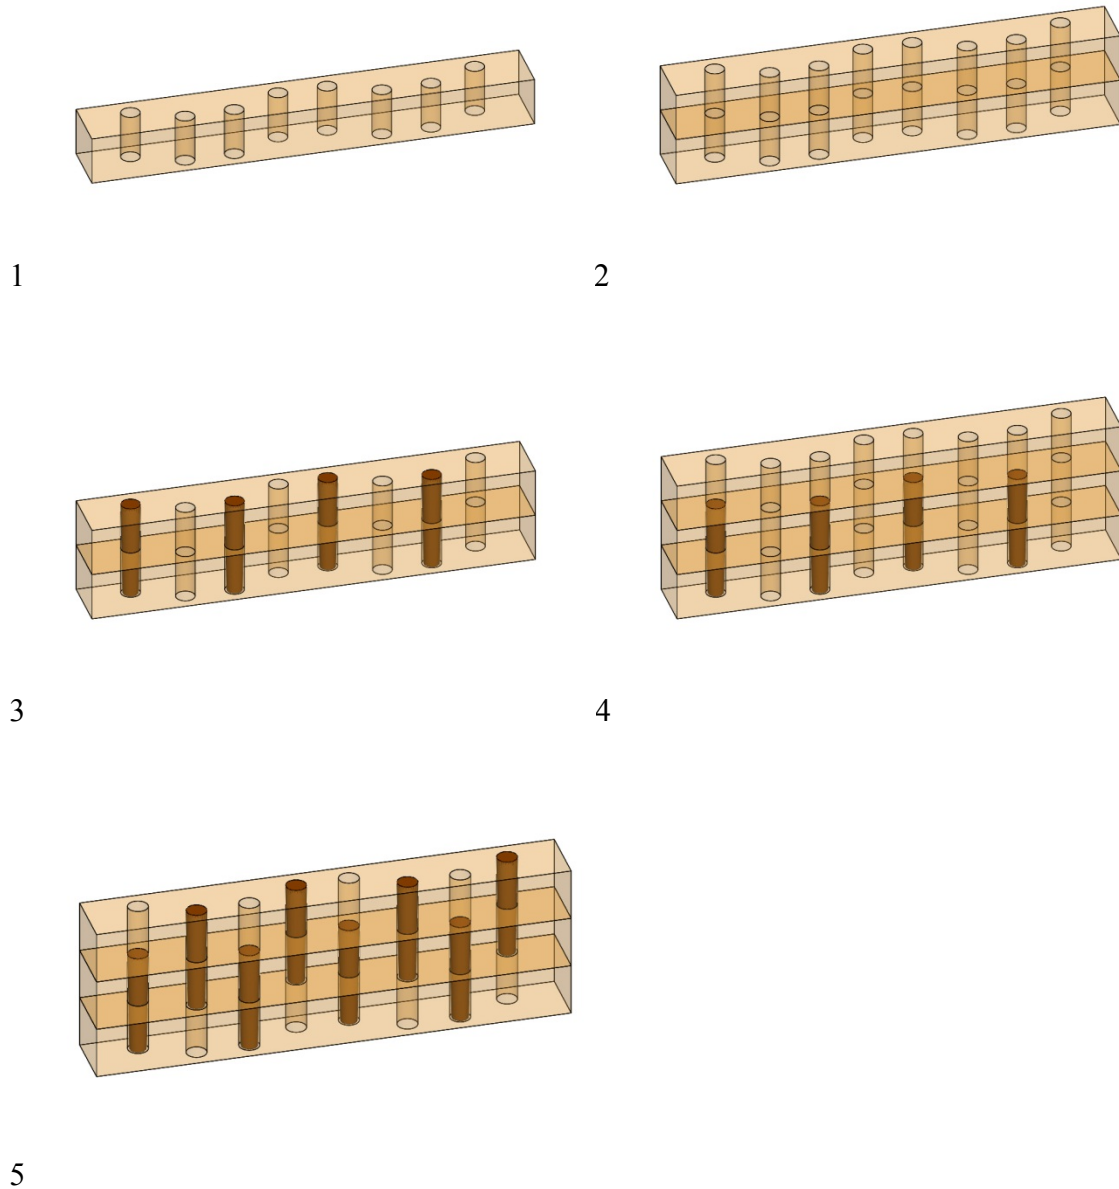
Étapes d'assemblage d'un panneau lamellé-soudé.
